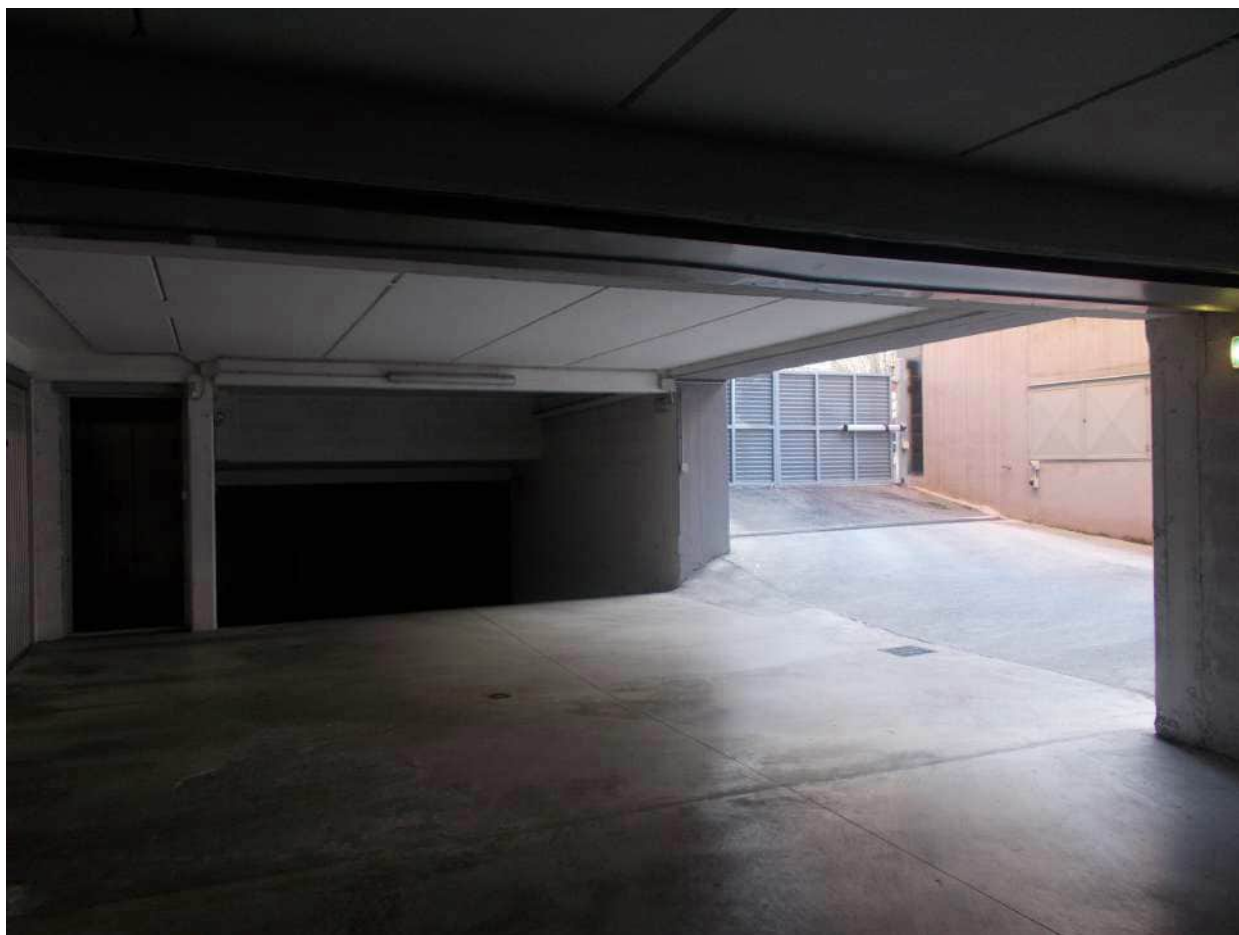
vista dell'ingresso ai locali autorimesse lungo Via Damiano Chiesa e dell'ingresso del locale Centrale Termica.
